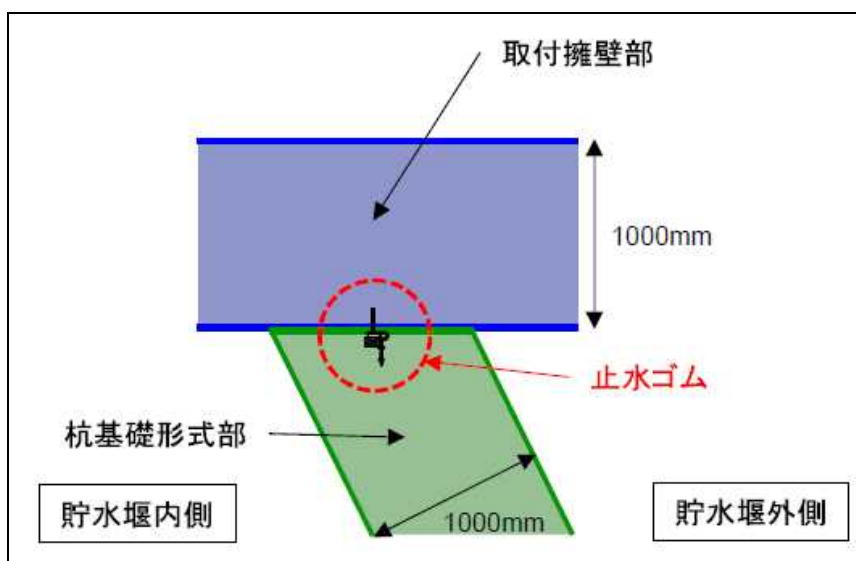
止水ゴム設置概要平面図 (関西電力 大飯 3, 4 号炉)
